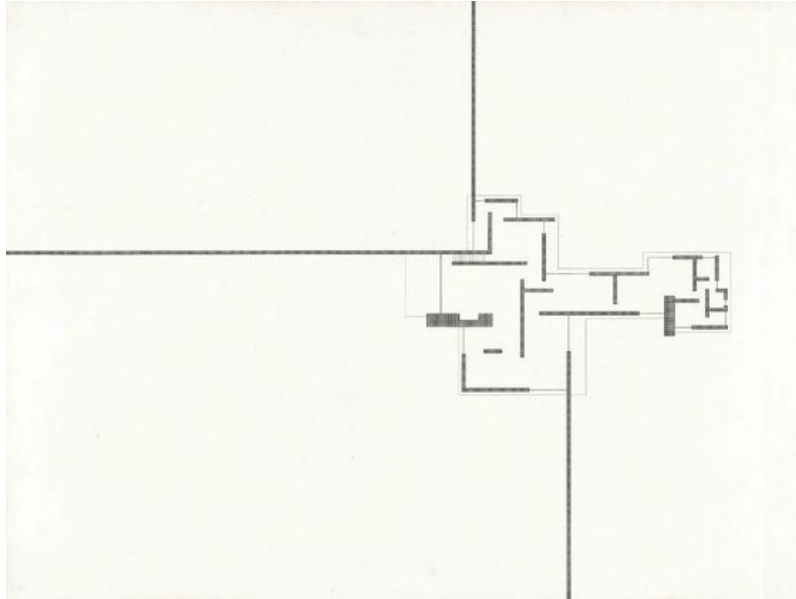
Planta da Casa de Campo em Tijolos, 1924.
